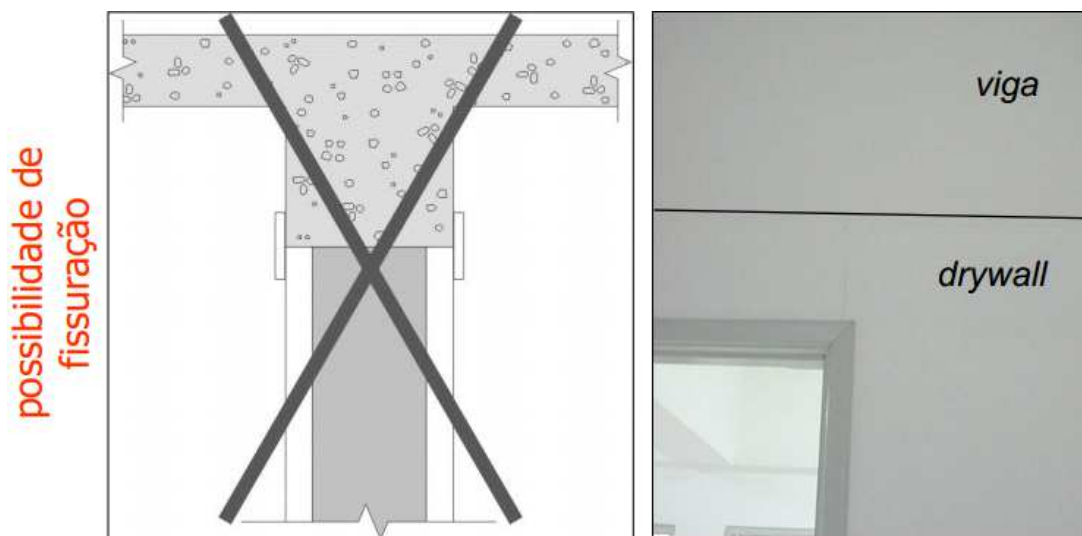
Tratamento de juntas com possibilidade de fissuração no encontro de pilares e vigas (MITIDIERI, 2012)
